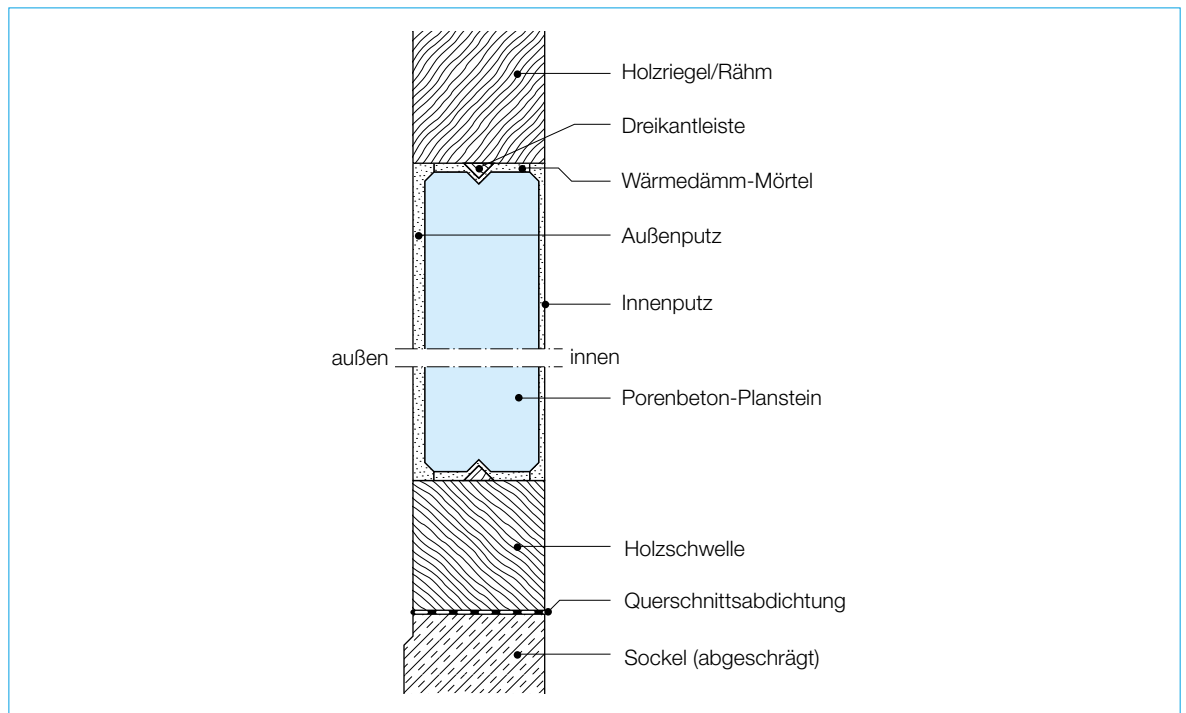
Ausmauerung von Holzfachwerk mit Porenbeton, Horizontalschnitte
